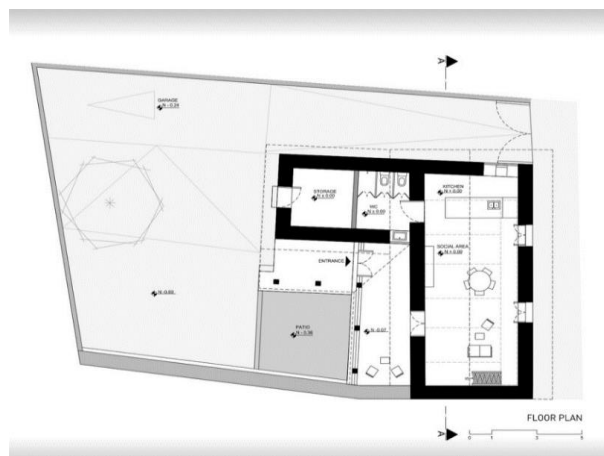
Planta con muros originales - Fuente: (BORDE, 2019)
